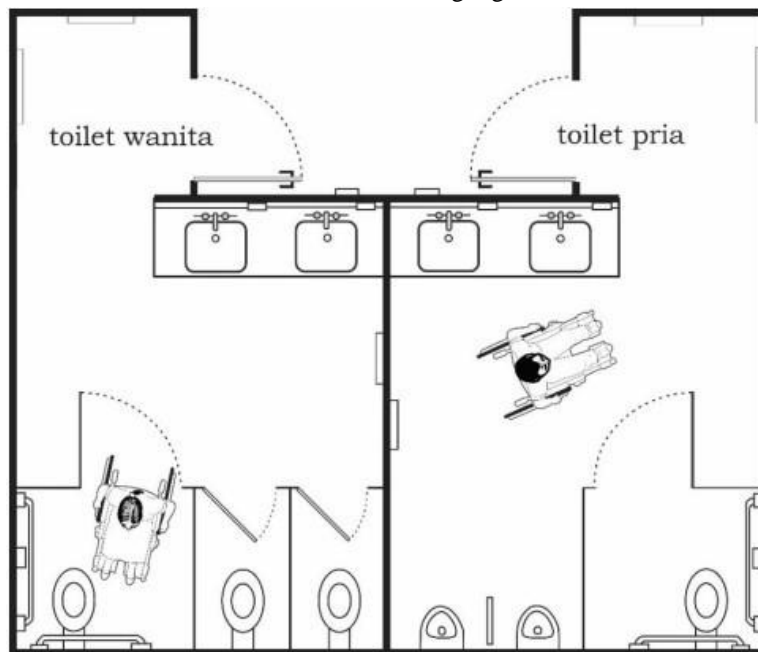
Dimensi Minimal ruang dalam toilet penyanggah disabilitas
